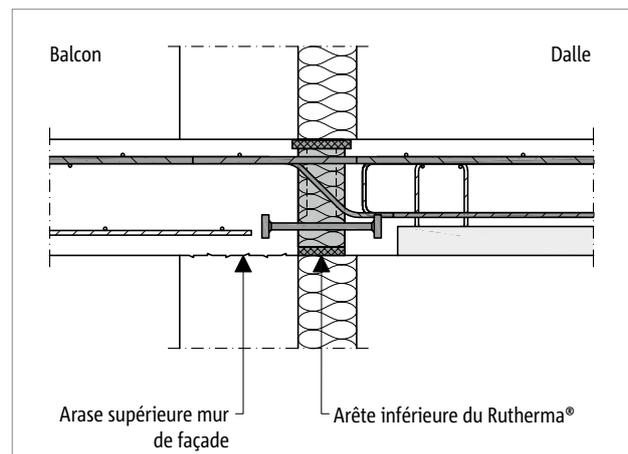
Schöck Rutherma® T type DB : balcon en béton coulé sur place avec plancher constitué de prédalles sur mur en béton armé
